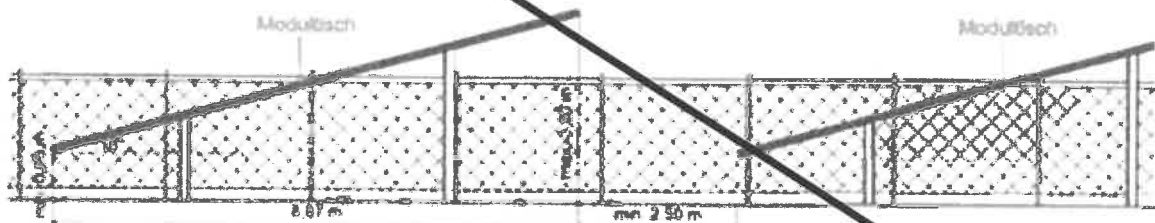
Skizze der Modulkonstruktion (Quelle: Planungsunterlagen)
